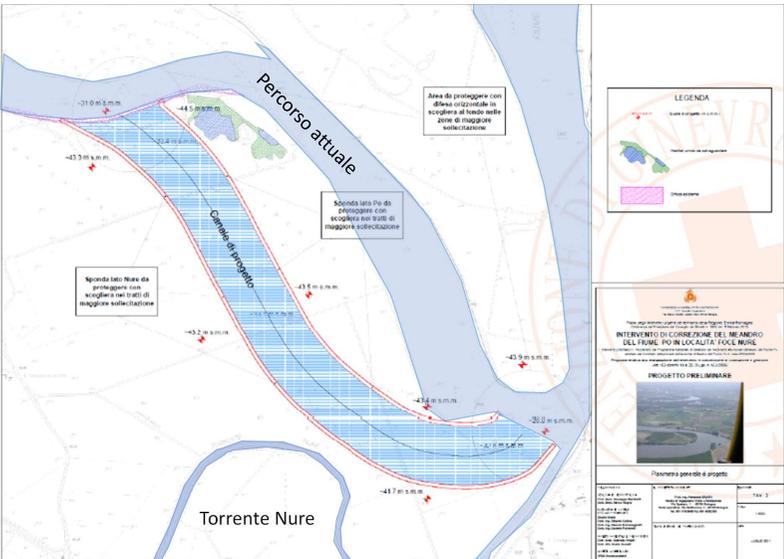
Progetto preliminare presentato da CCC a firma dell'Ing. Idraulico Armando Brath
